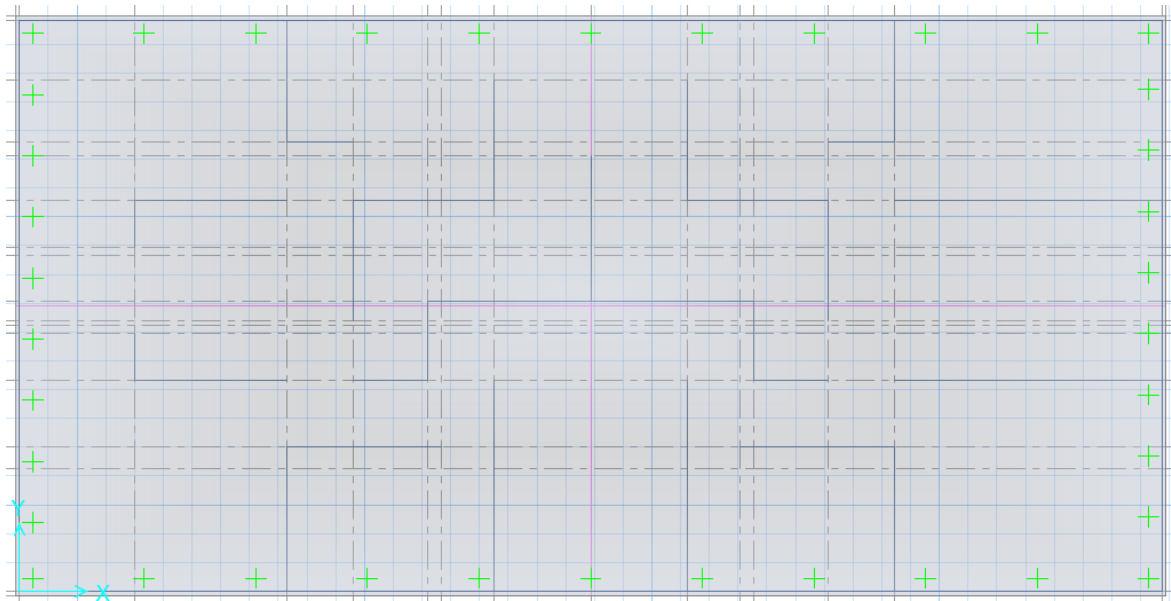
Planteamiento de la placa de cimentación para la edificación de MDL.
